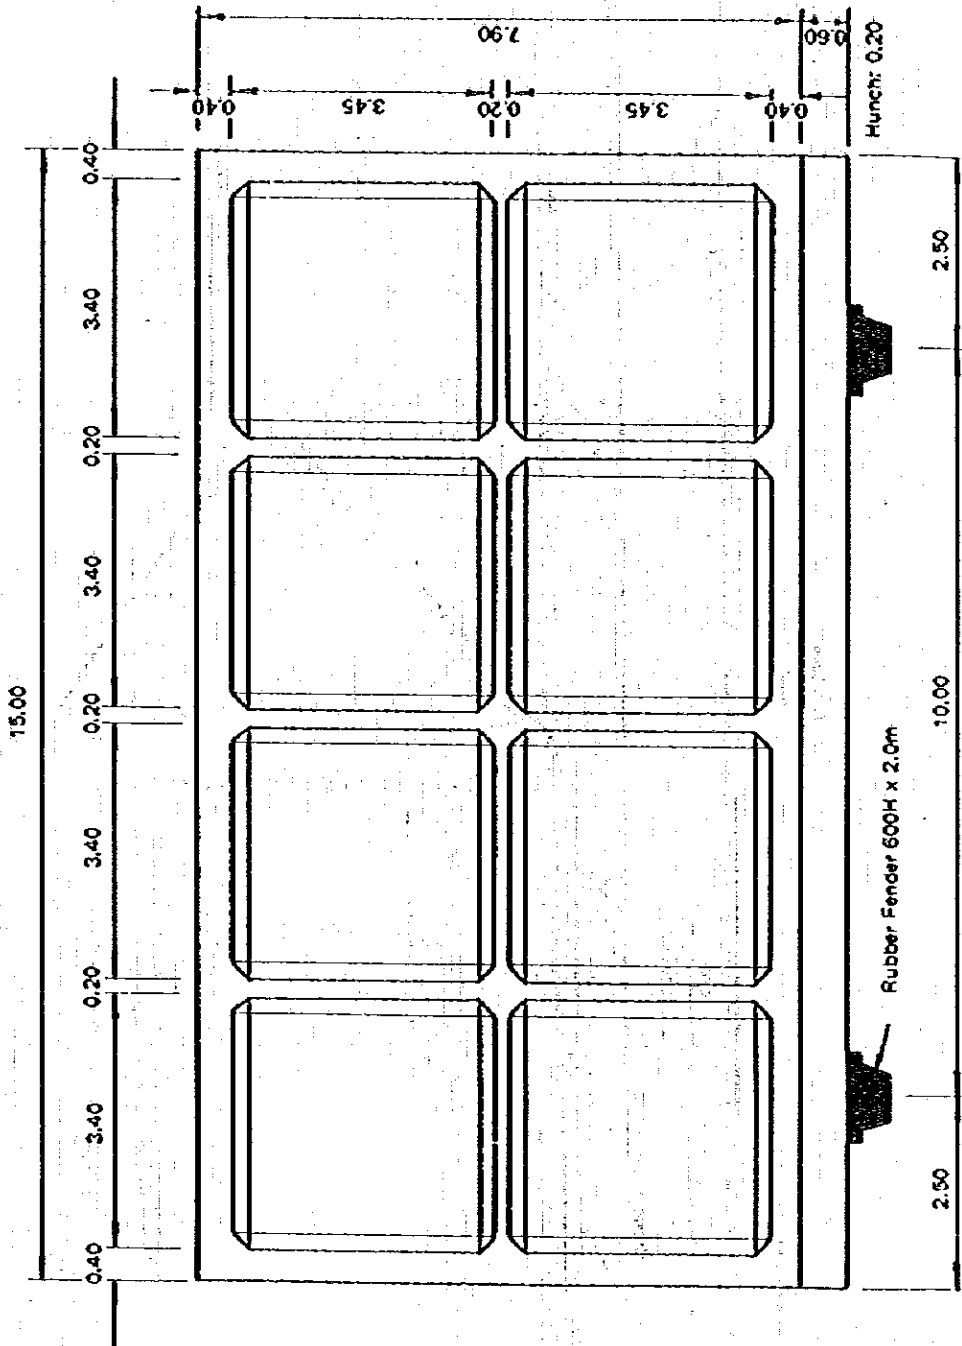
4 (a) 鋼矢板セイル基礎断面図 (D 案)
